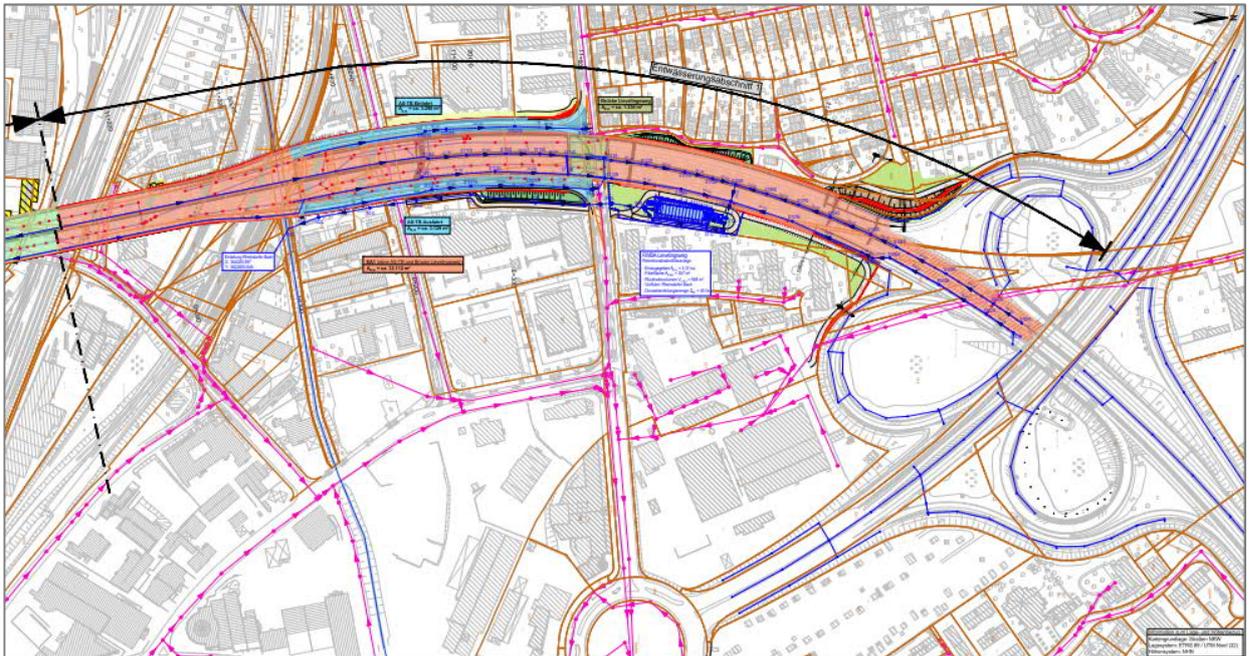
Lageplan nördlicher Entwässerungsabschnitt EA1, RWBA Lievelingsweg und Einleitung in den Rheindorfer Bach (Quelle: Unterlage 8.1/2)
